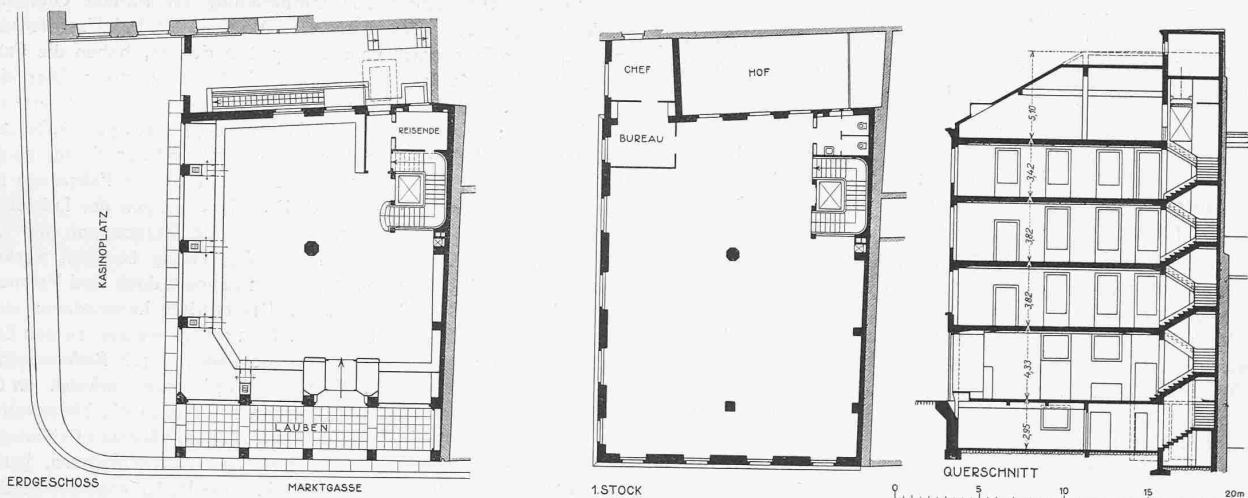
Geschäftshaus Wiegner, Winterthur. Grundrisse vom Erdgeschoss und 1. Stock, und Querschnitt. — Masstab 1 : 400.
